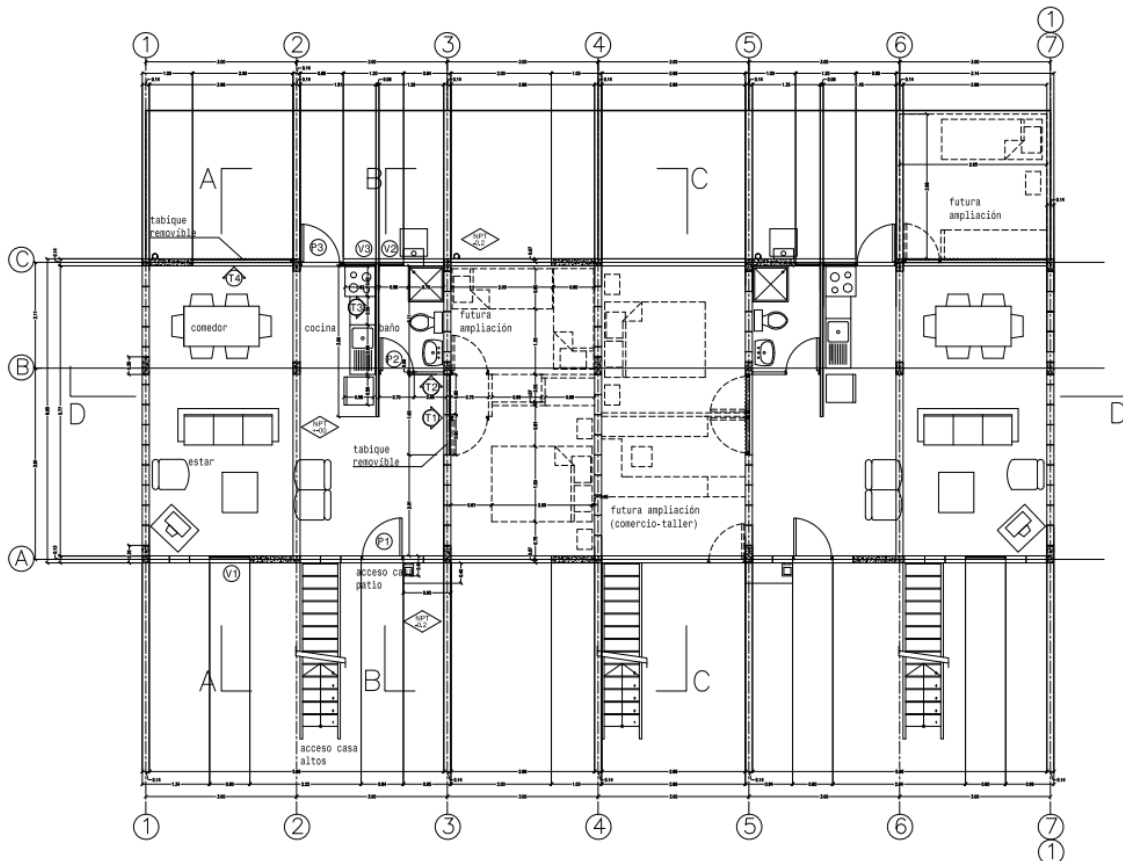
Planta primeiro nível. Fonte: Projeto Elemental – Quinta Monroy, 2016.
